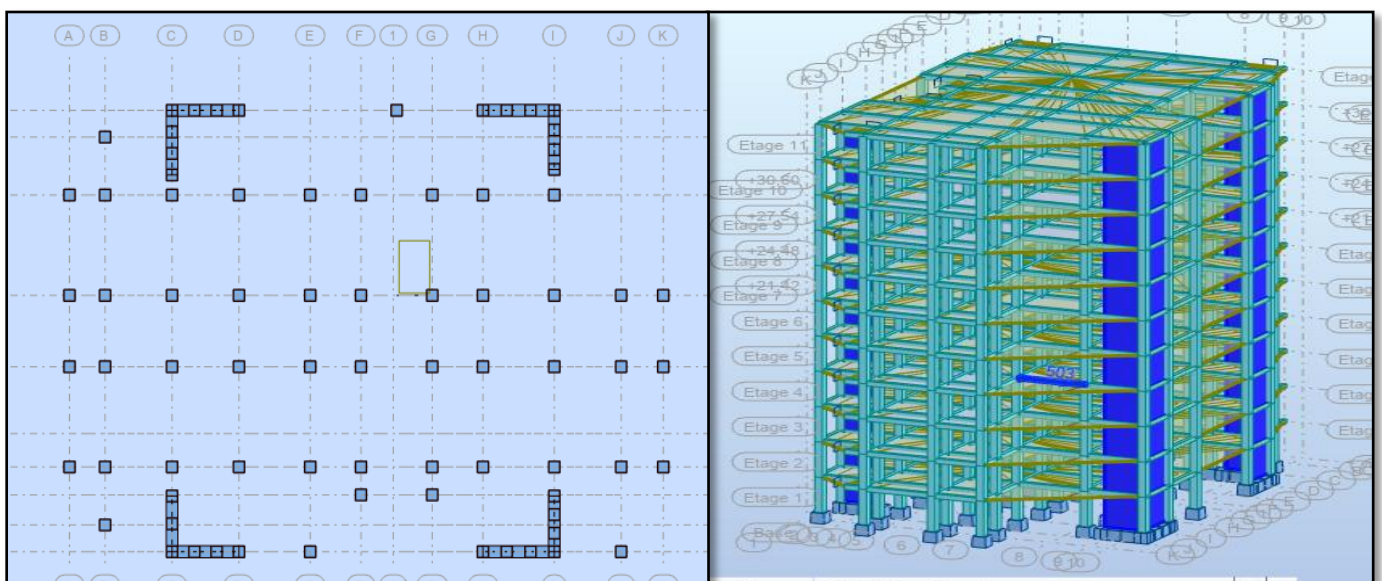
Vue en plan et en élévation de la 1^{ère} variante.
